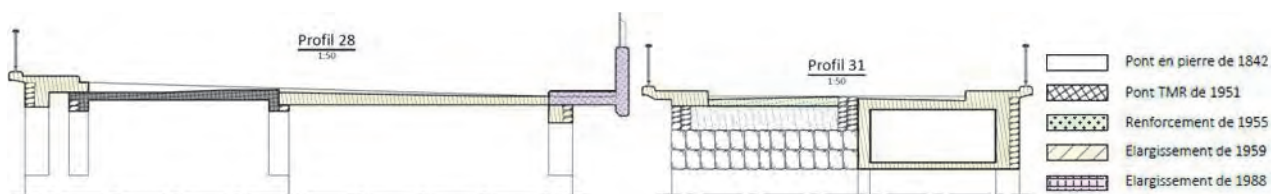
Coupes types (profil 28 : sur la voie ferroviaire / profil 31 : sur la Dranse)
